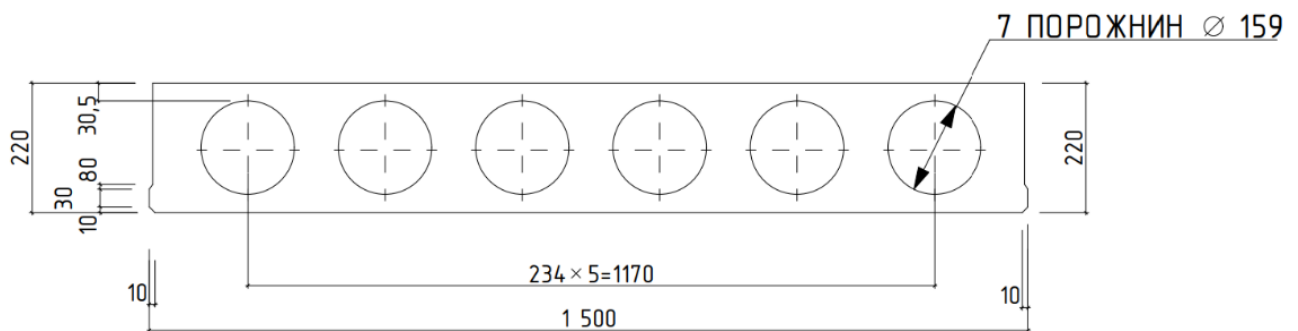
Поперечний переріз багатопустотної плити перекриття
